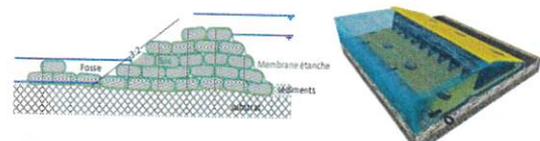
Coupe transversale du seuil en mur poids (à gauche) et illustration d'une barrière amovible (à droite, WaterGate® - MegaSecure)
